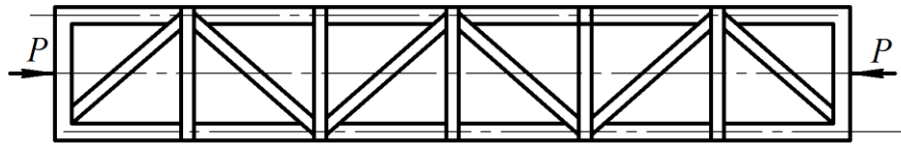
Соединительная решётка с дополнительными стойками
